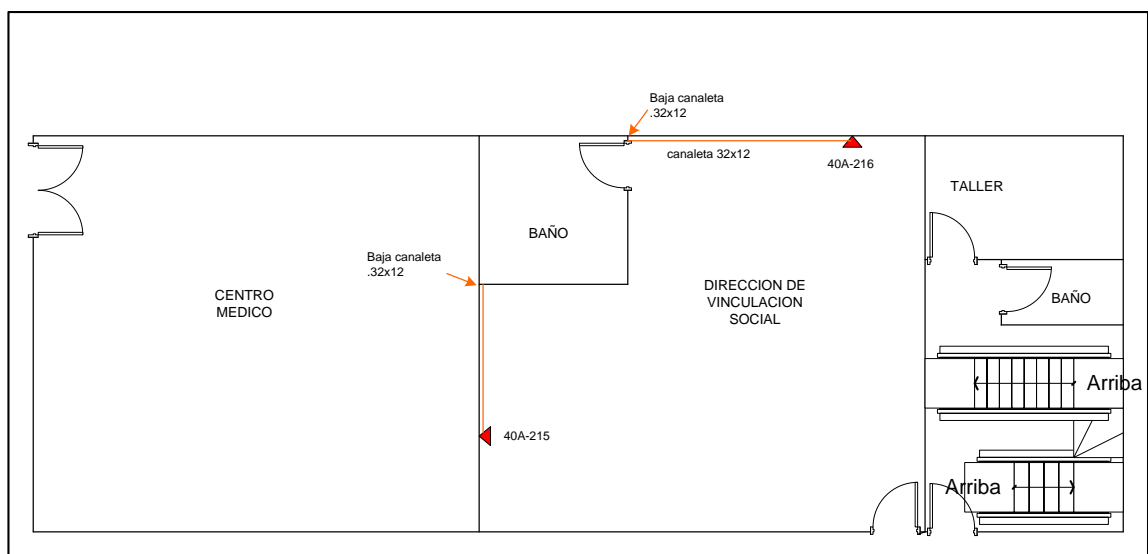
Plano de Comunicación Primera Planta –Edificio Verde
